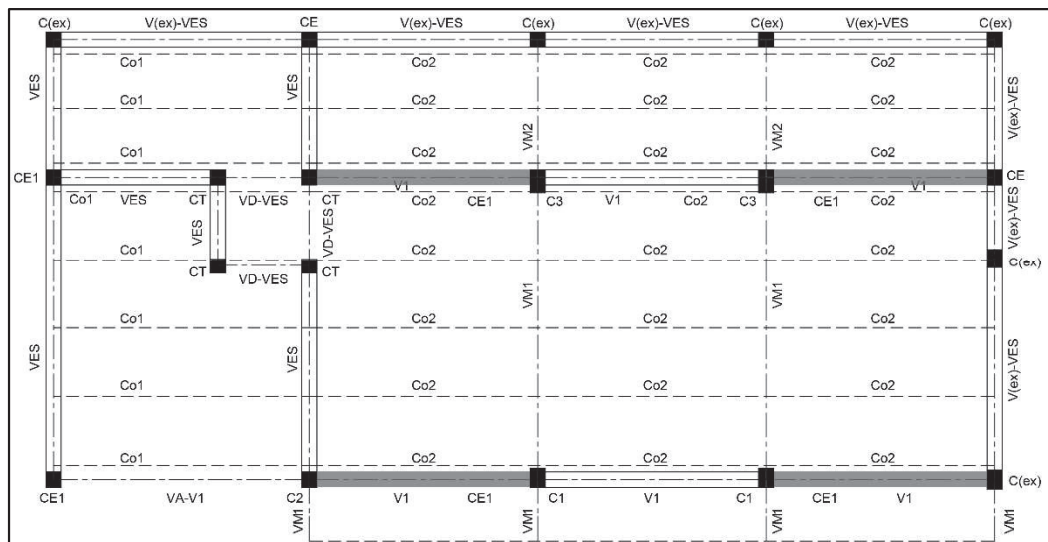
Planta estructural propuesta. Los tramos 2 y 4 de las vigas V1 se muestran sombreados.
